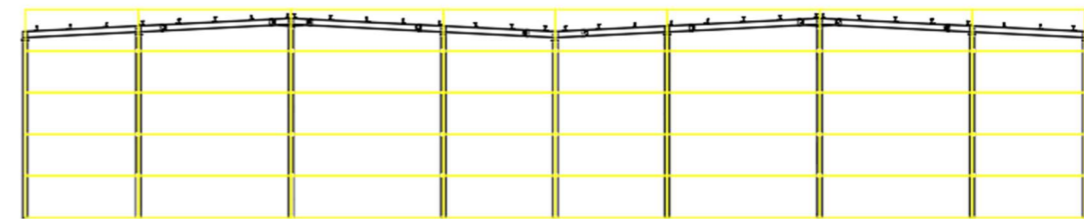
Disposición paneles de cerramiento en fachada hastial.
